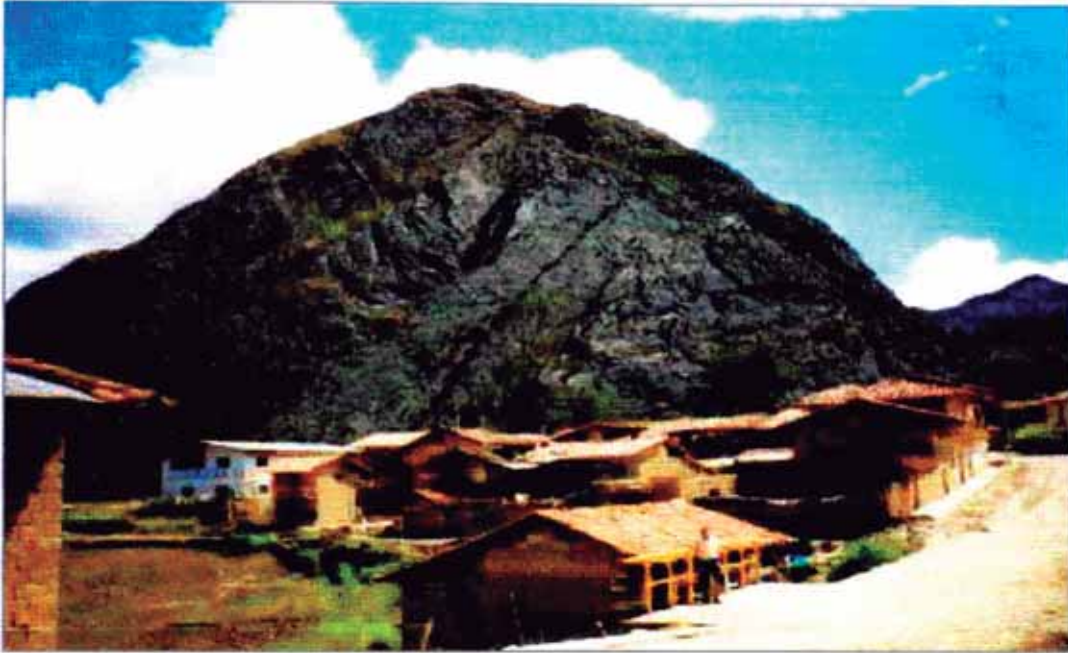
VISTA DESDE EL PUENTE. VIVIENDAS RECIEN CONSTRUIDAS
